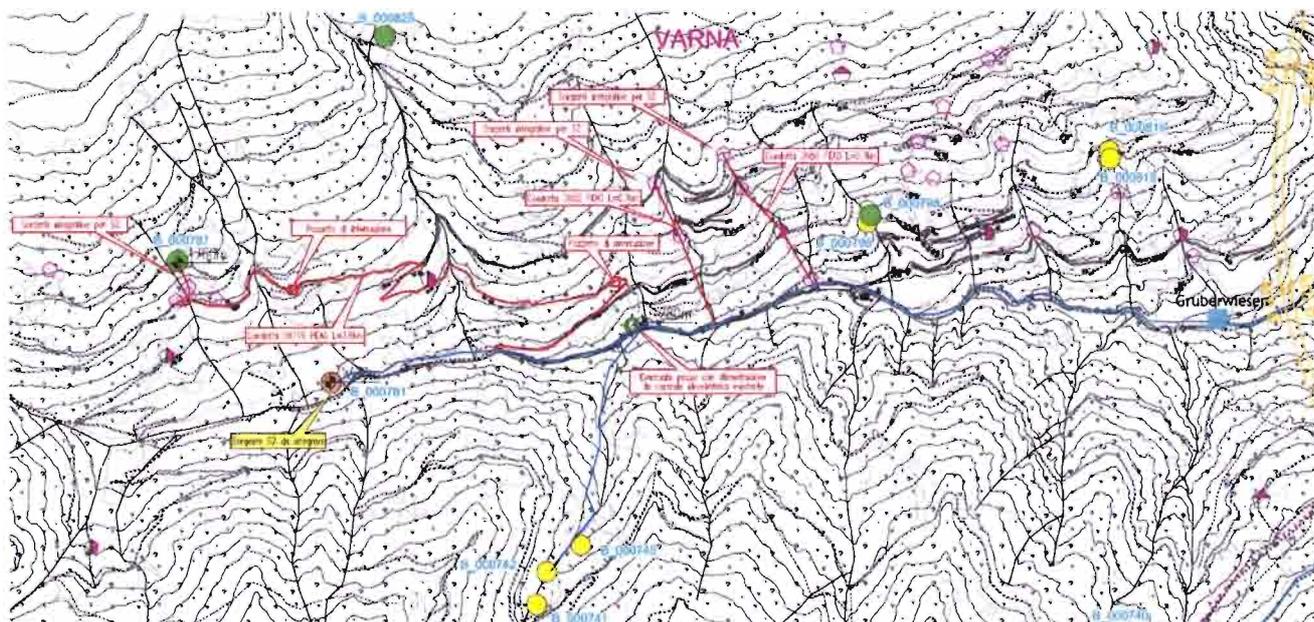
Stralcio planimetrico della soluzione progettuale selezionata.
